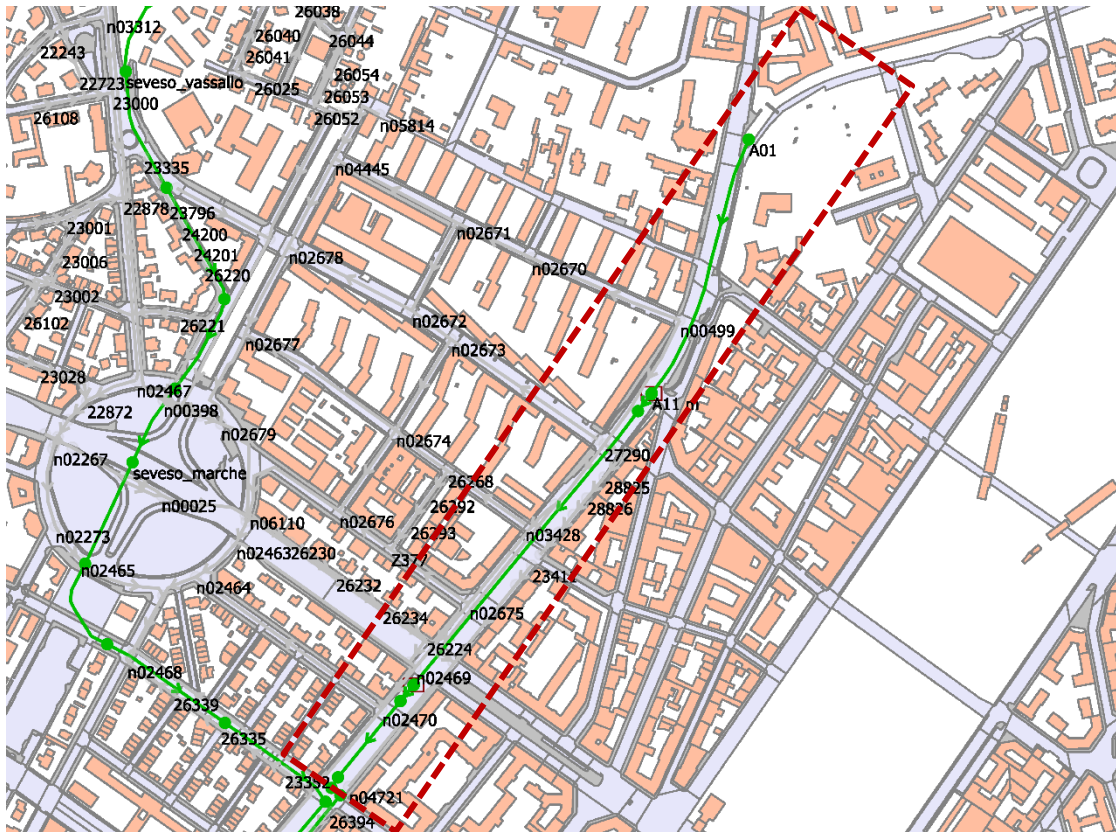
“Tratta A - Planimetria: canale in via M. Gioia da Cassina de Pomm a via Carissimi”
